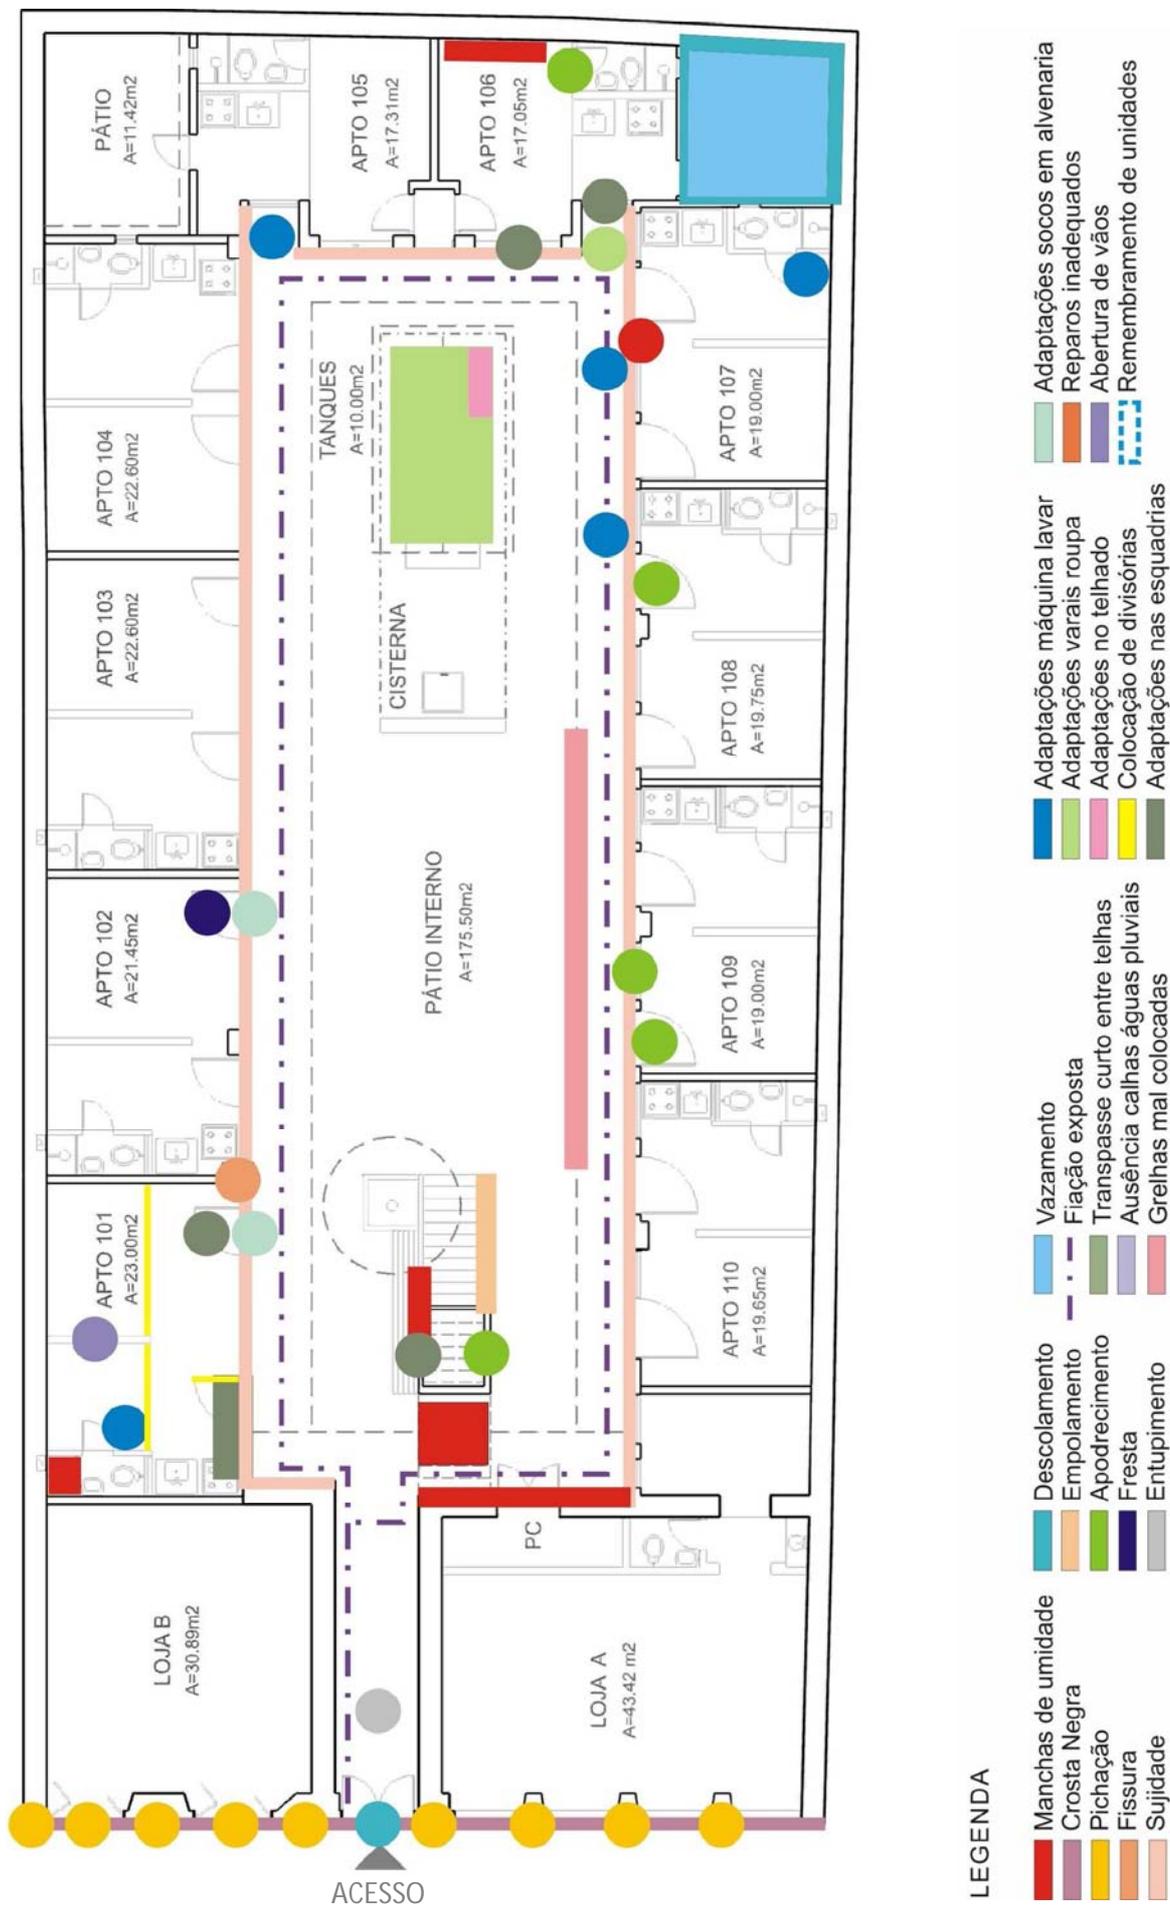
Mapeamento de Danos e Apropriações. Pavimento superior. Sem escala. 2008.
